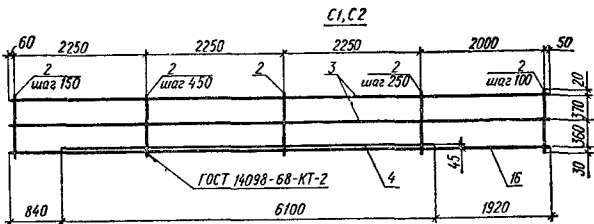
Армирование главной балки сварными сетками:
